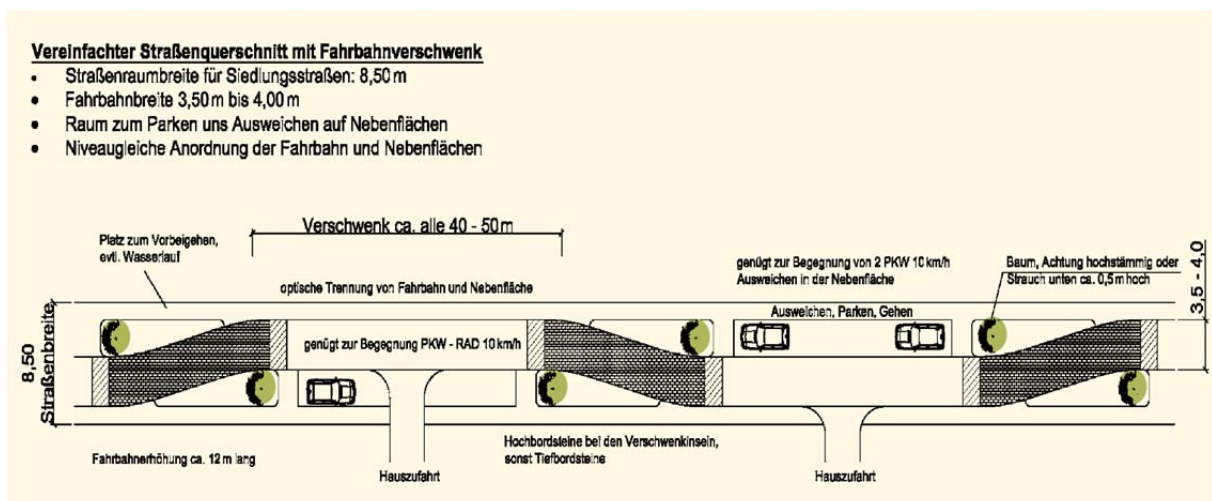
Beispiel für einen „vereinfachten“ Straßenlängsschnitt (Grundriss) im unterrangigen Netz.²¹
